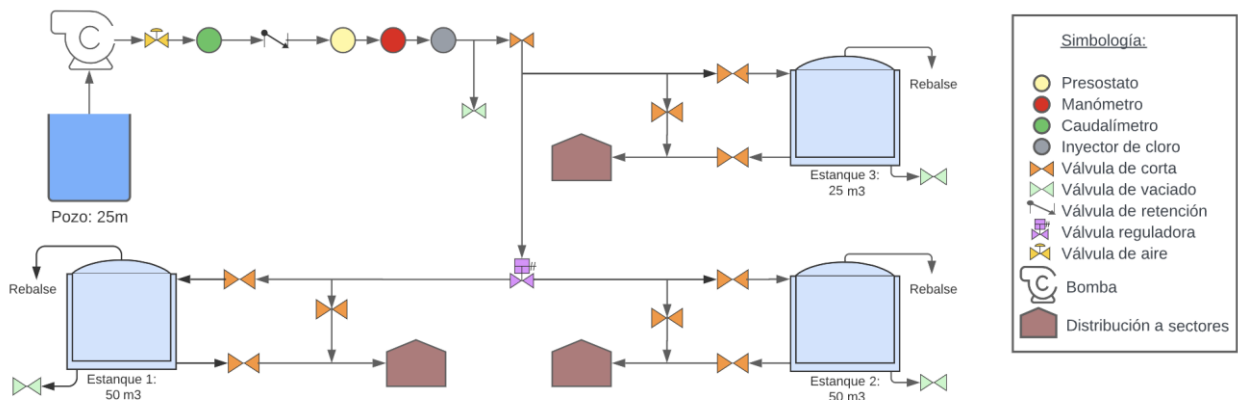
Layout impulsión APR Rapel. Fuente: Elaboración propia.
